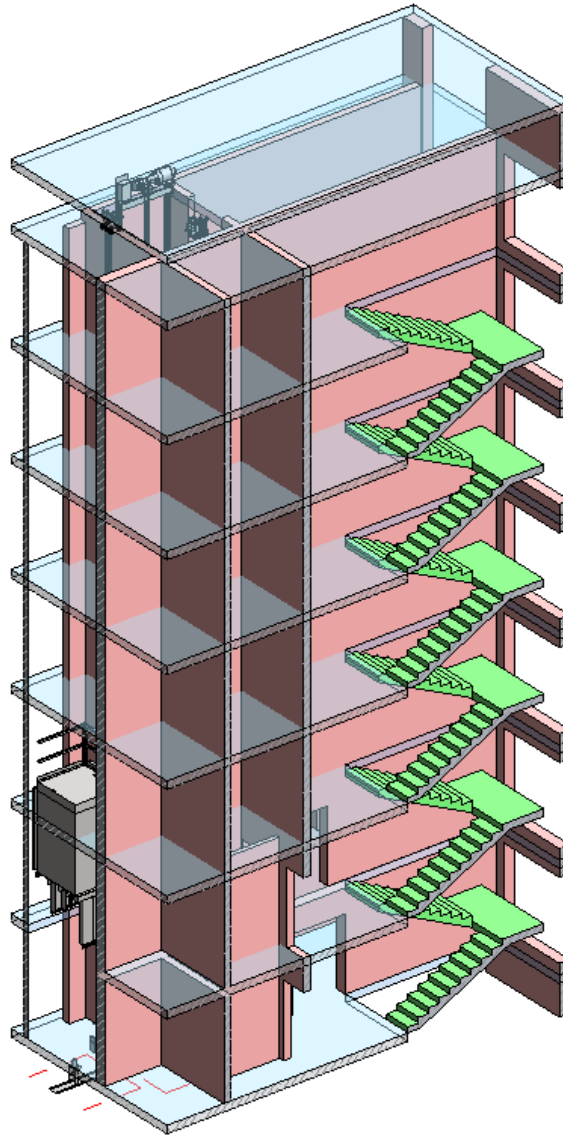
Схема влаштування ліфтового вузла та незадимлювальних сходів
